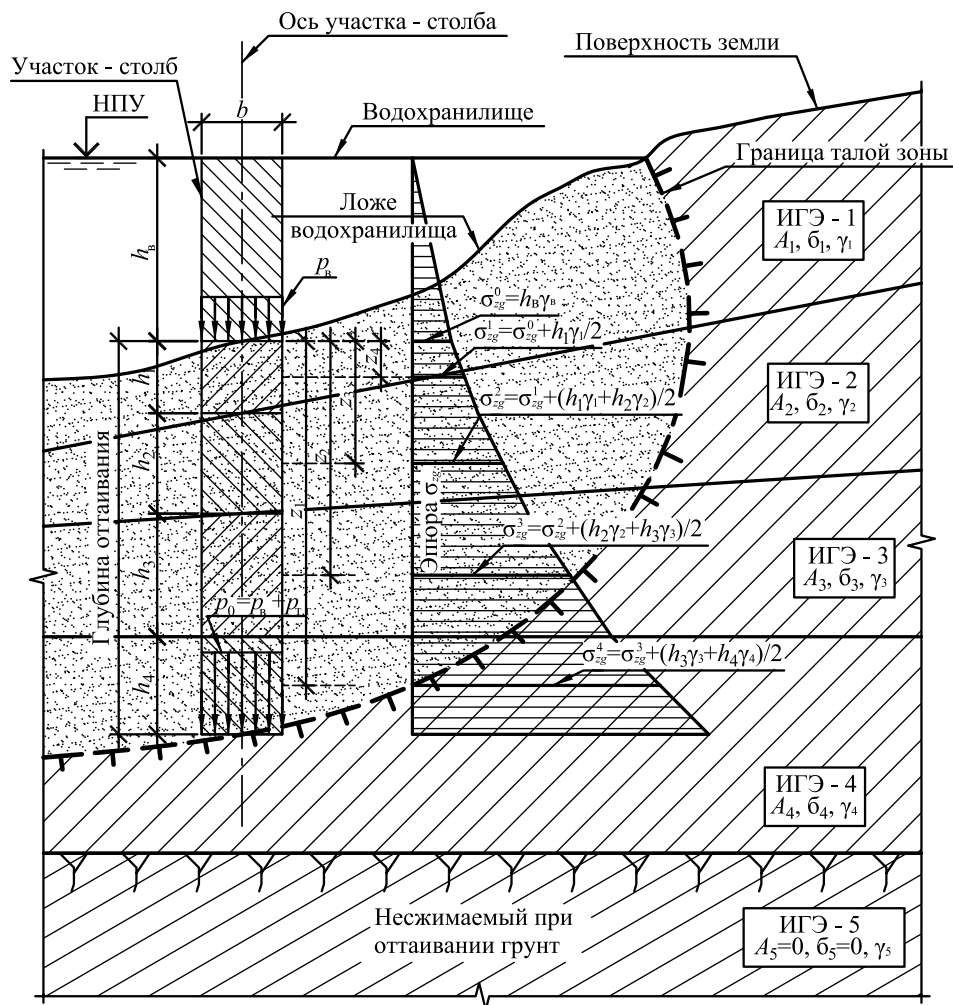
Схема к расчету тепловой осадки грунта основания водохранилища при расположении границы талой зоны выше кровли несжимаемого при оттаивании грунта
